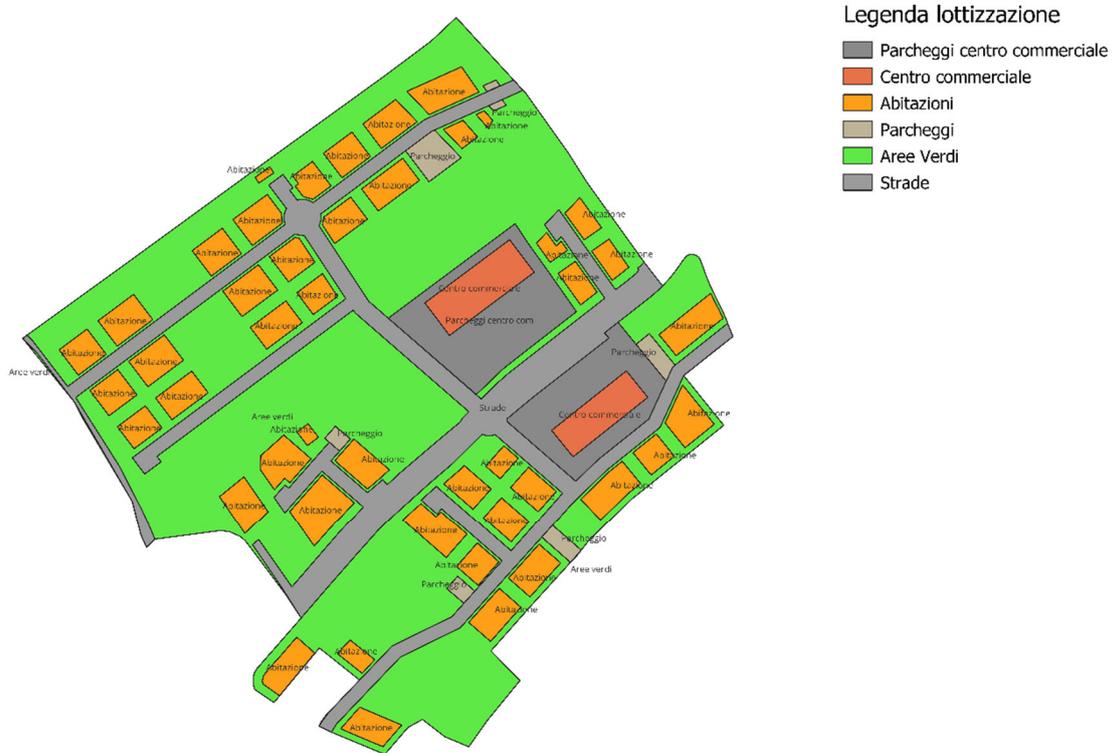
Proposta di planivolumetrico – P.I.N. Santa Lucia
